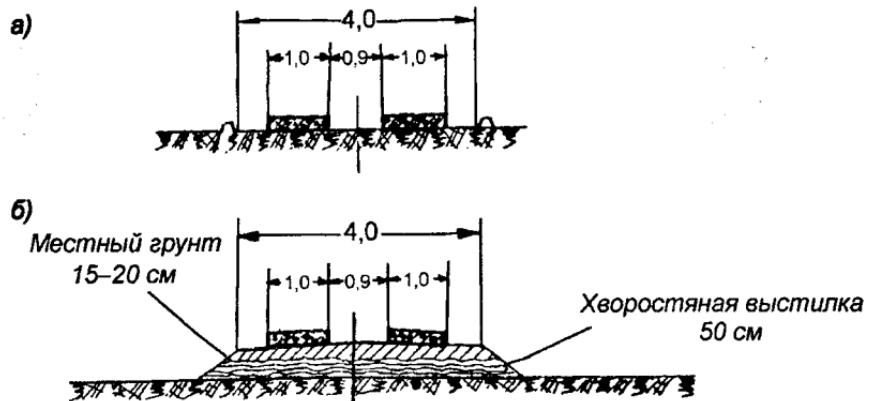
Типовые поперечные профили колейного железобетонного покрытия автомобильных дорог на усах.
